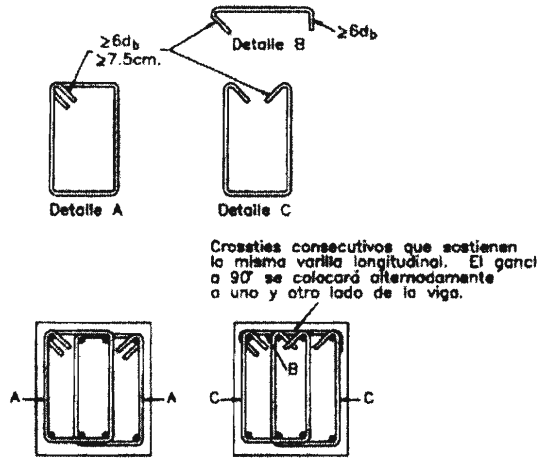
refuerzo transversal en elementos sometidos a flexión
